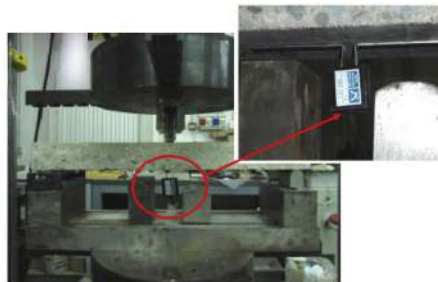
Flexão em três pontos para pré-fissuração (FERRARA *et al.*, 2014)
